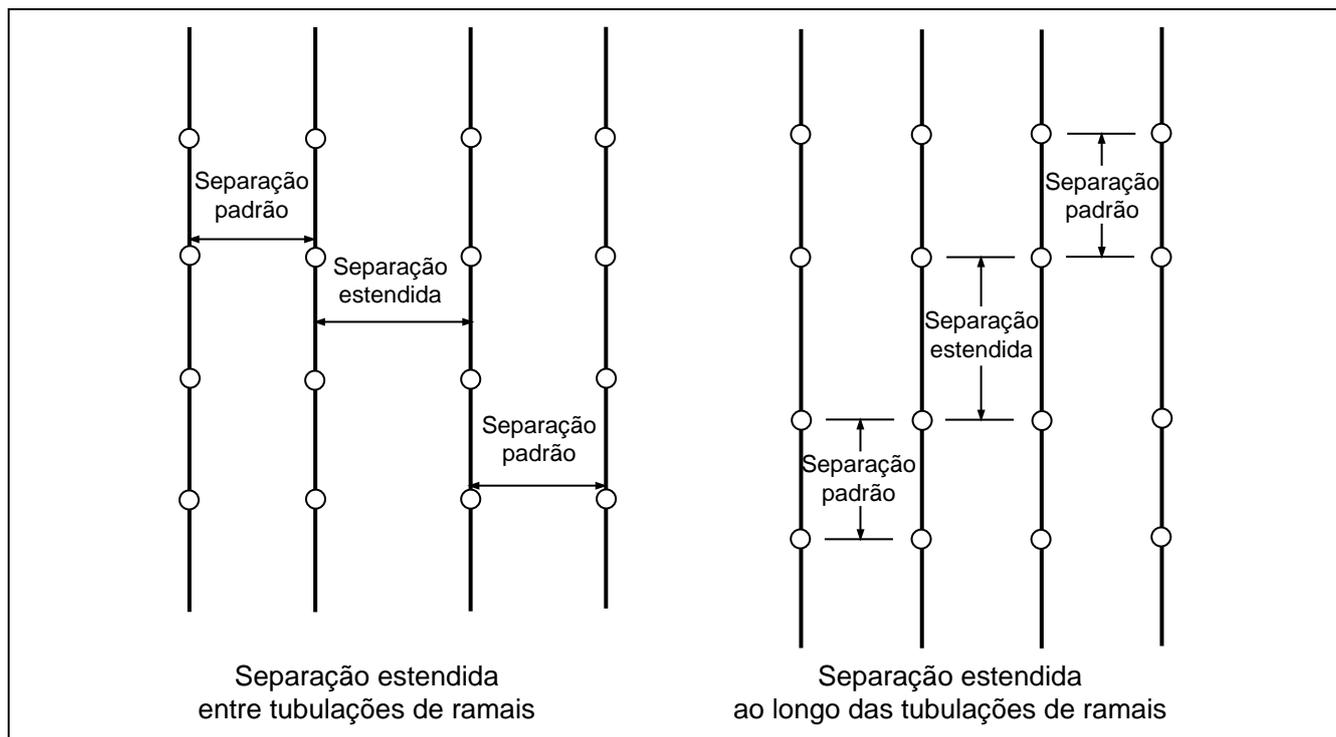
Aumento máximo da separação linear e área de cobertura de sprinklers para uso geral para evitar obstruir a descarga do sprinkler.
